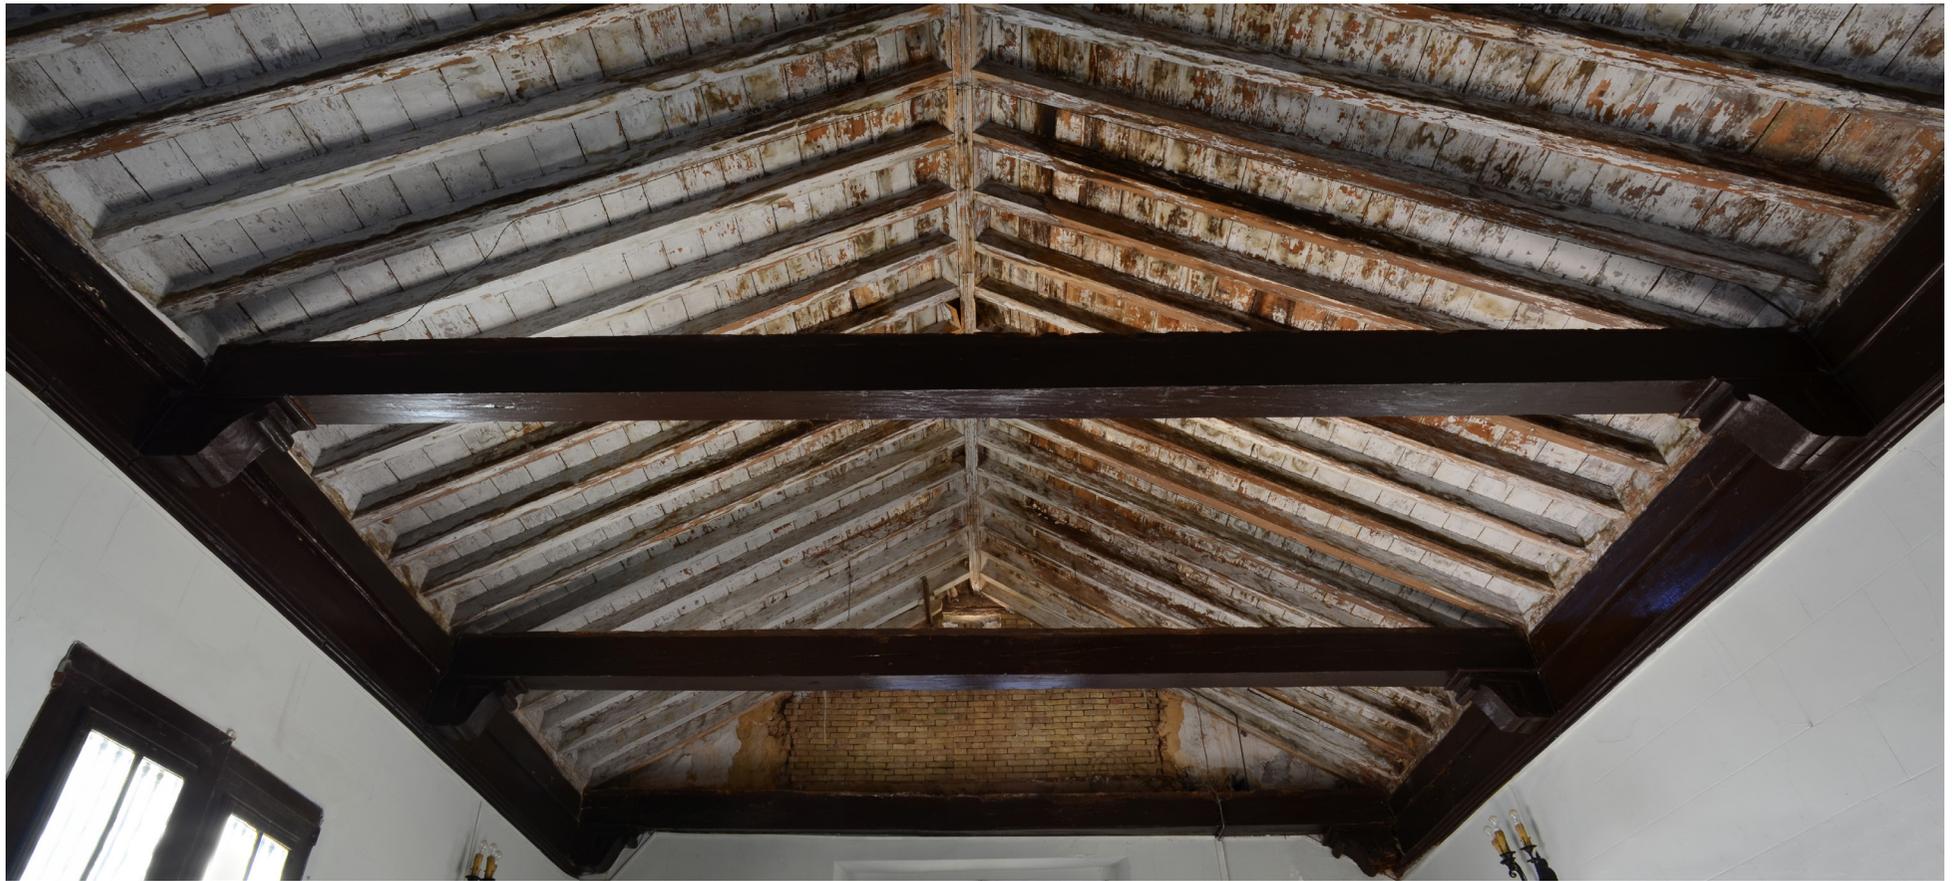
Estructura de Cubierta de la Ermita de San Bartolomé. Requena
